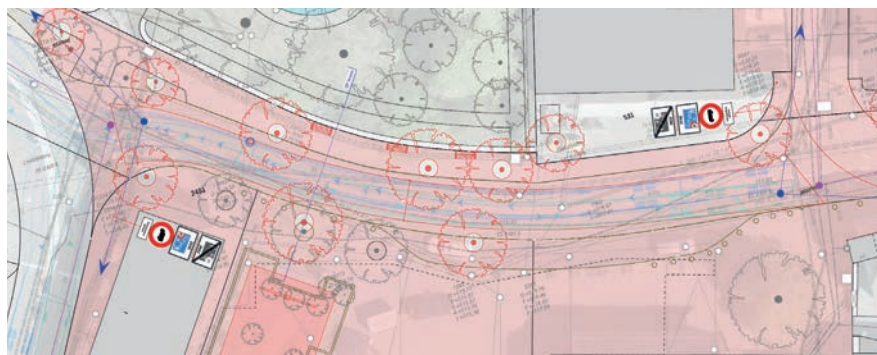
Situationsplan Dorfstrasse / Kreuzplatz – Strassenbreite 4.2 m mit Trottoirüberfahrten, Werkleitungen und Schleppkurven
